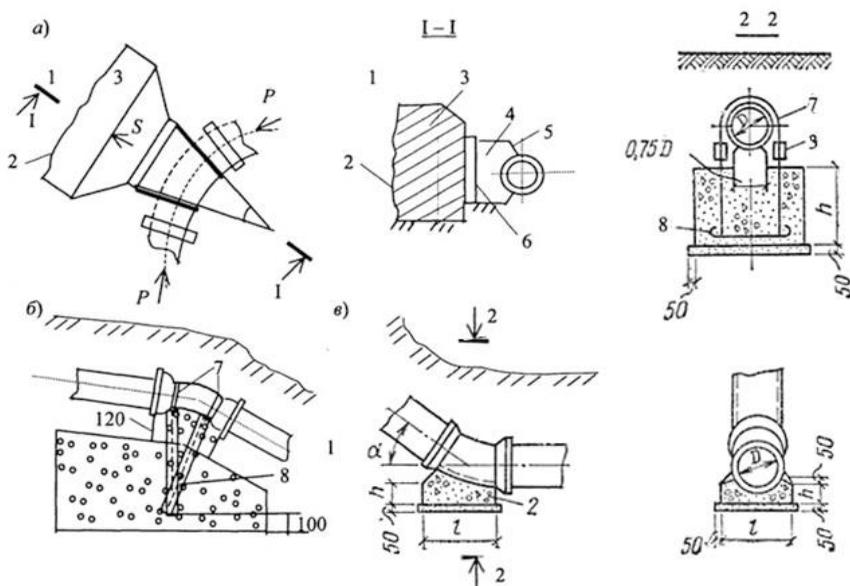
Упоры для чугунных подземных раструбных трубопроводов:
